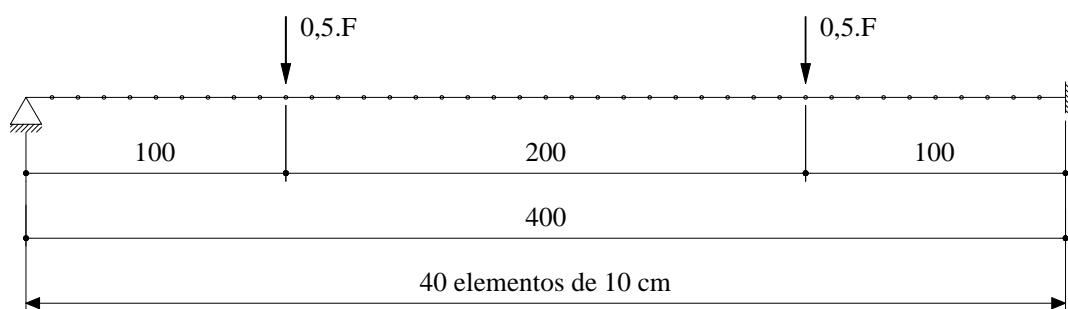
Discretização longitudinal (dimensões em cm)
